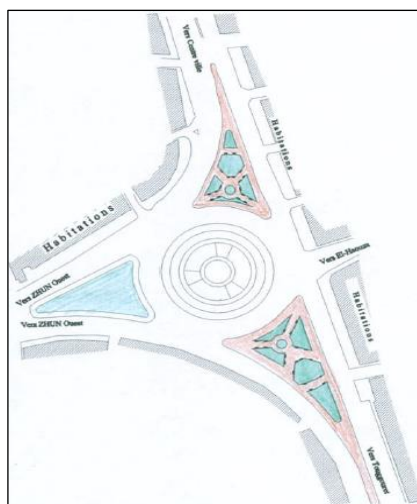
Plan de masse de la placette de la révolution / Source: BET Barkat
